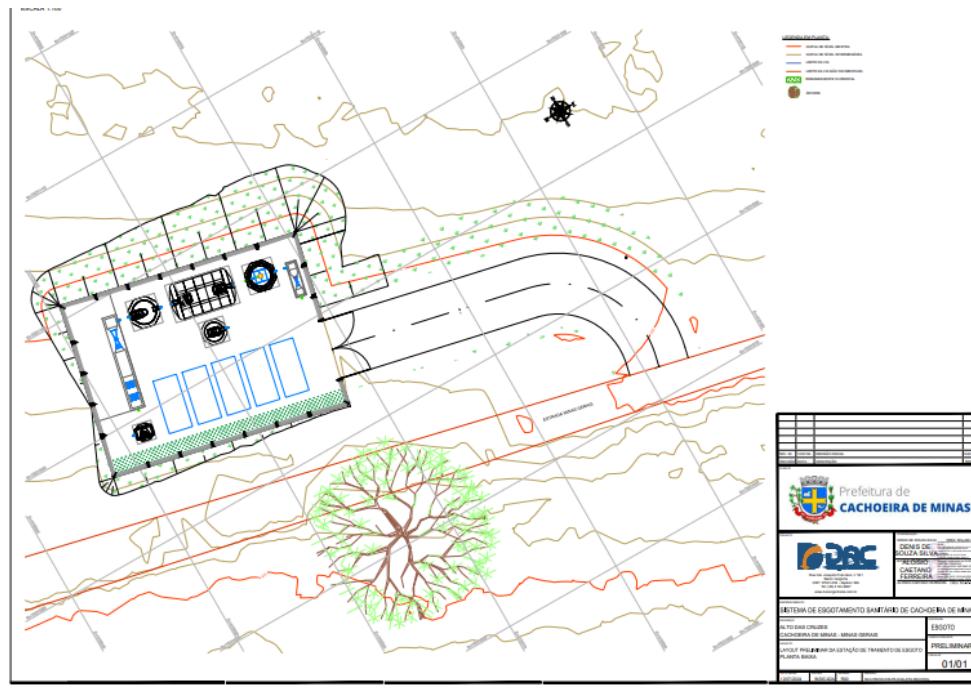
Projeto preliminar de tratamento de esgoto-Planta Baixa. Fonte: RCA.
